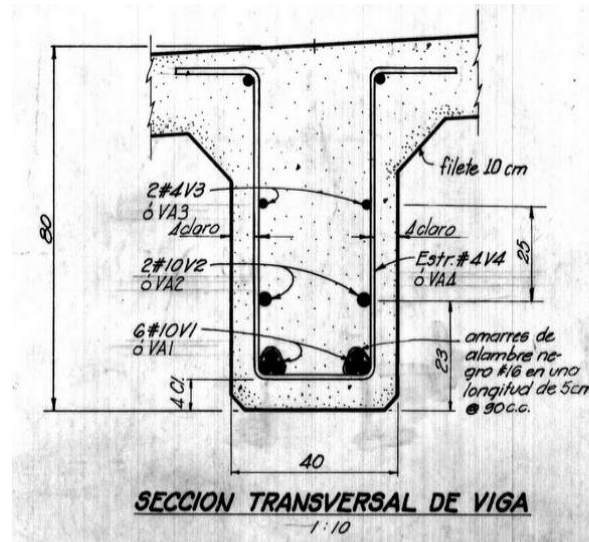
Sección transversal de viga simple tipo T del río Kooper en los tramos extremos donde existen daños por corrosión. Fuente: Planos disponibles para río Kooper en el sitio de SAEF, 2016
